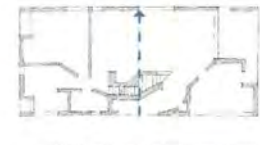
Geometrische Konstruktion des Grundrisses nach Ussish
